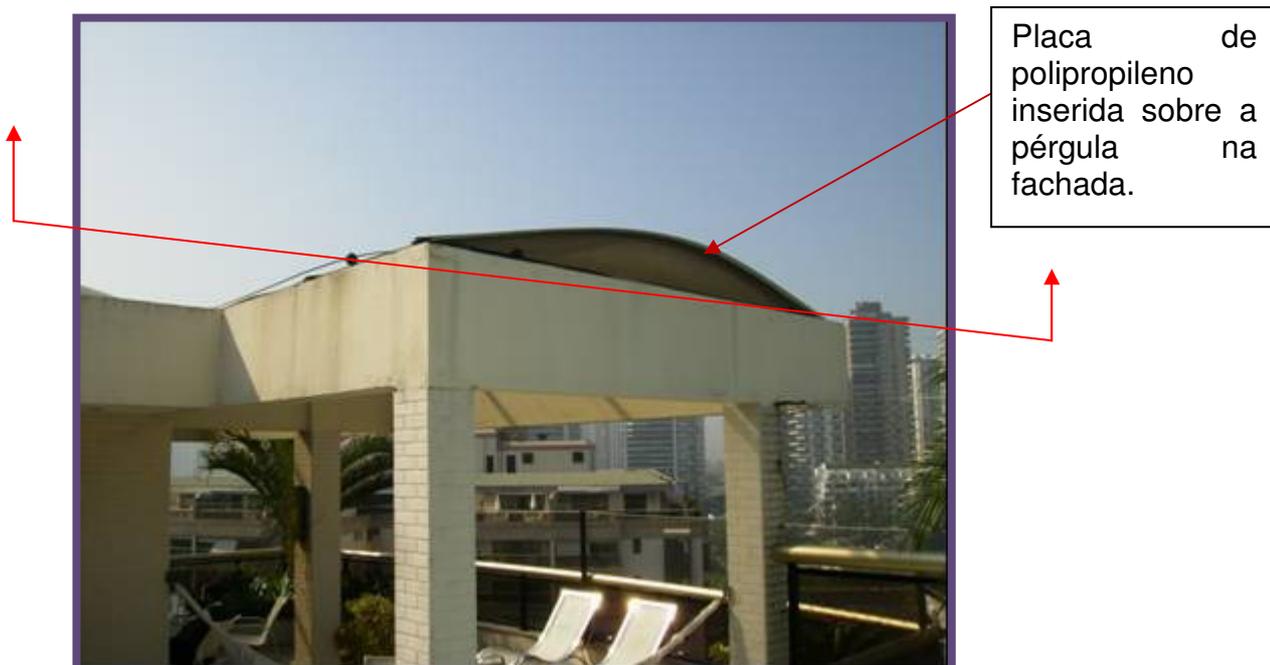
Elemento abobadado de fechamento, quebrando a harmonia da fachada.
